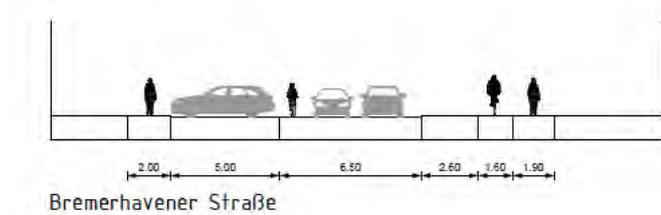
Bestehende Situation Bremerhavener Straße (Teil 2).
